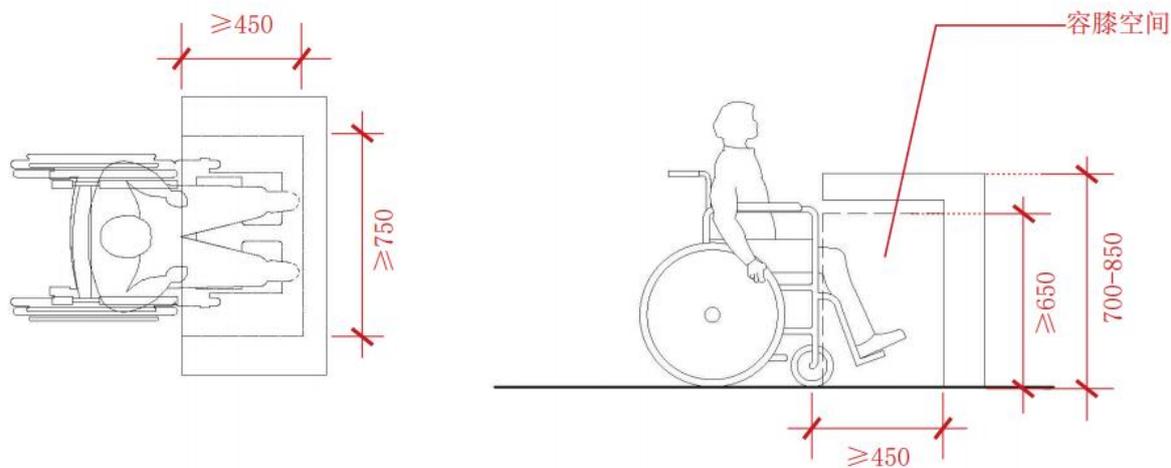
低位柜台及容膝空间示意图 (单位: mm)
